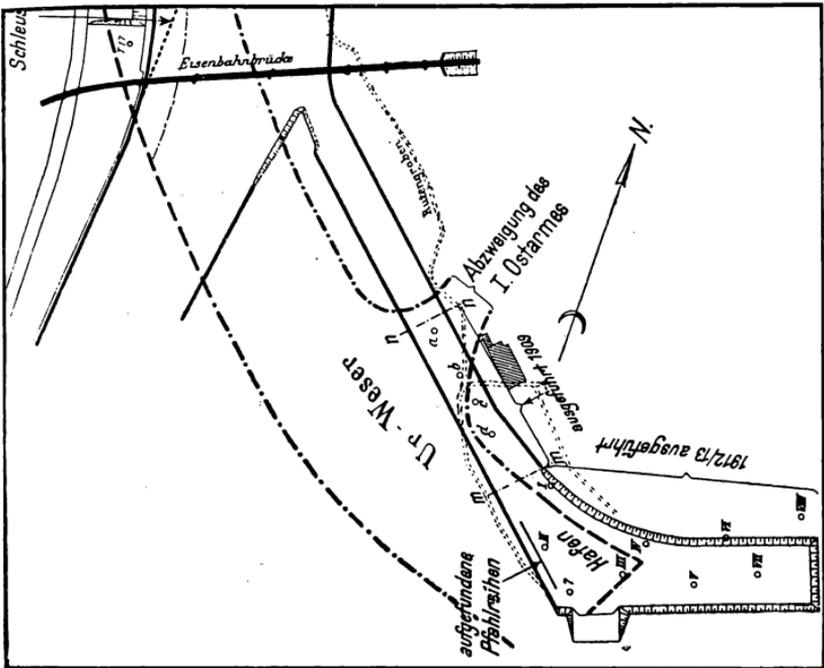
Lageplan der Bohrlöcher im Hamelner Hafen.
